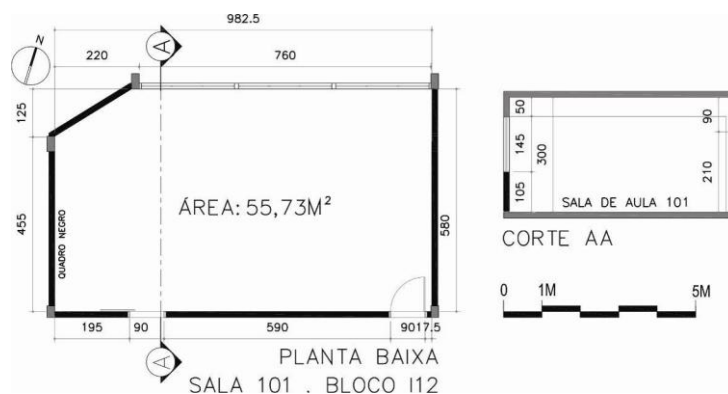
Planta baixa e corte da sala 101 do bloco I12
